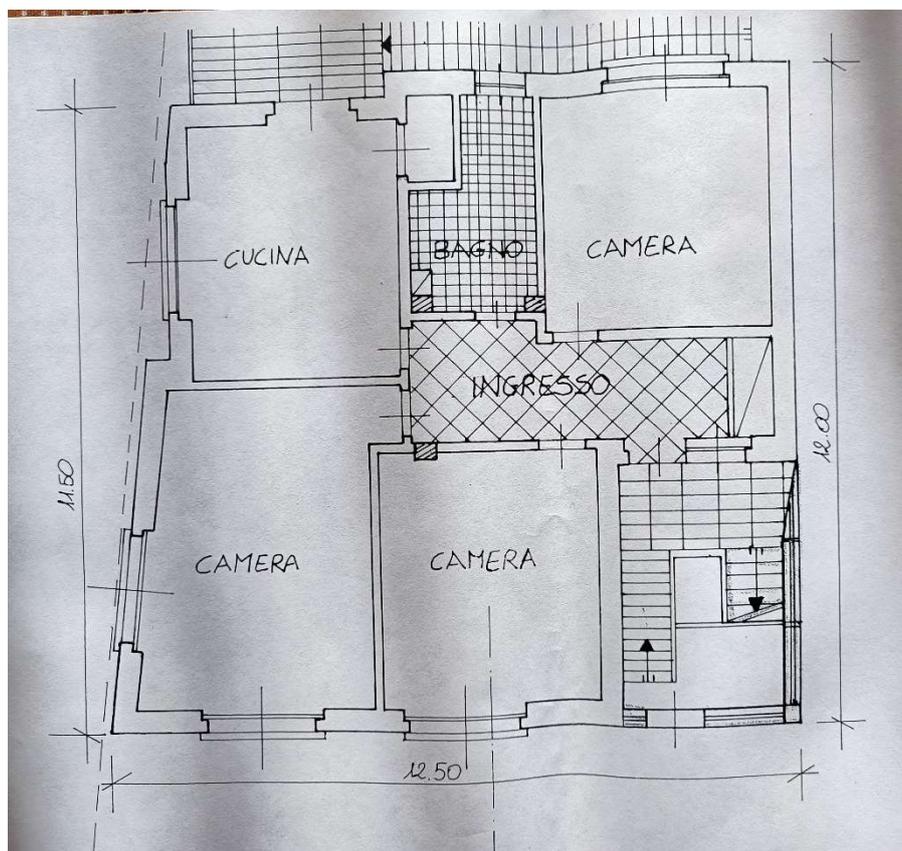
Planimetria p.1 e p.2 edificio oggetto di studio
